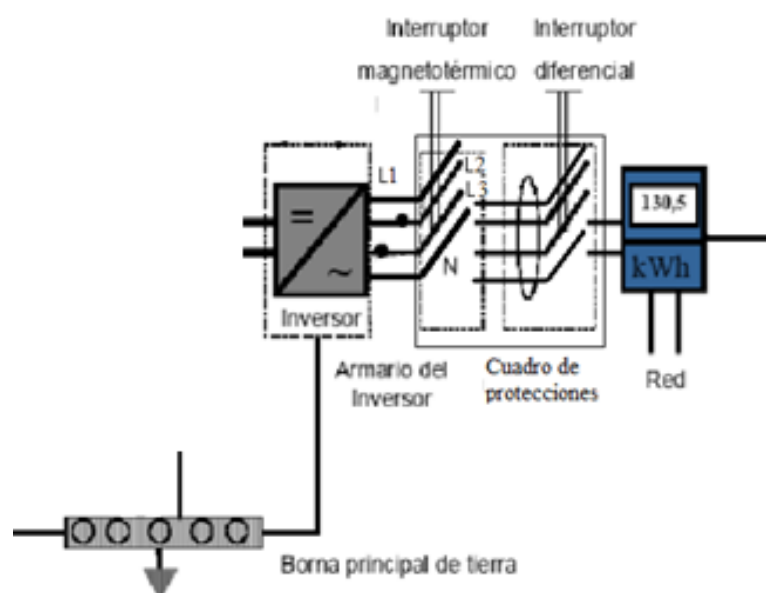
Configuración de las protecciones de la parte AC.
